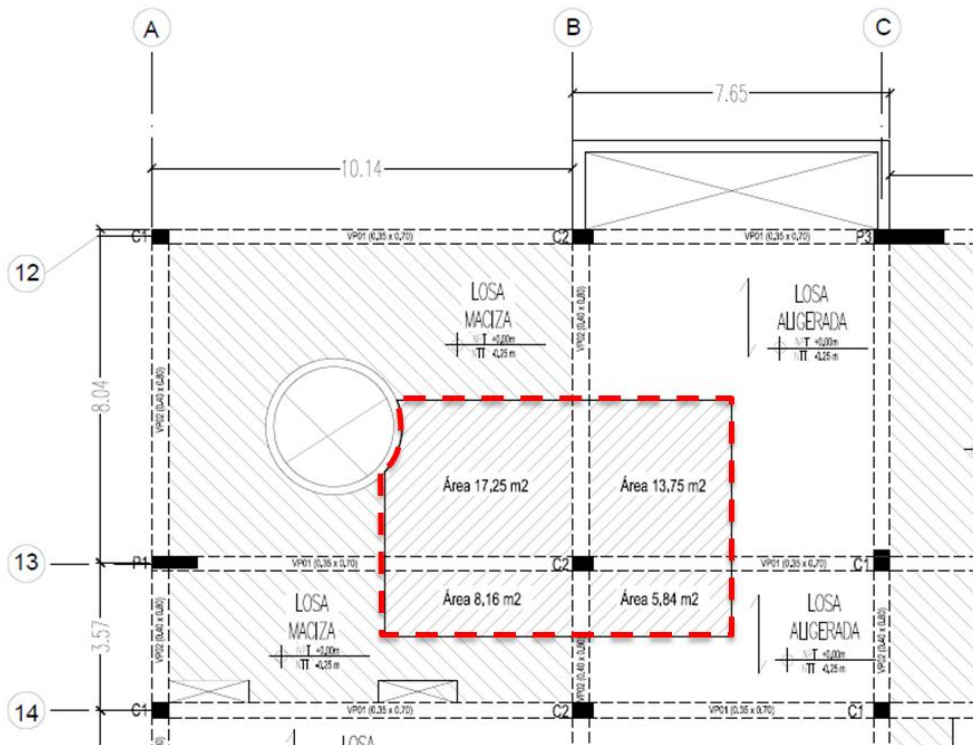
Área de influencia de columna C-2, en el primer piso.
